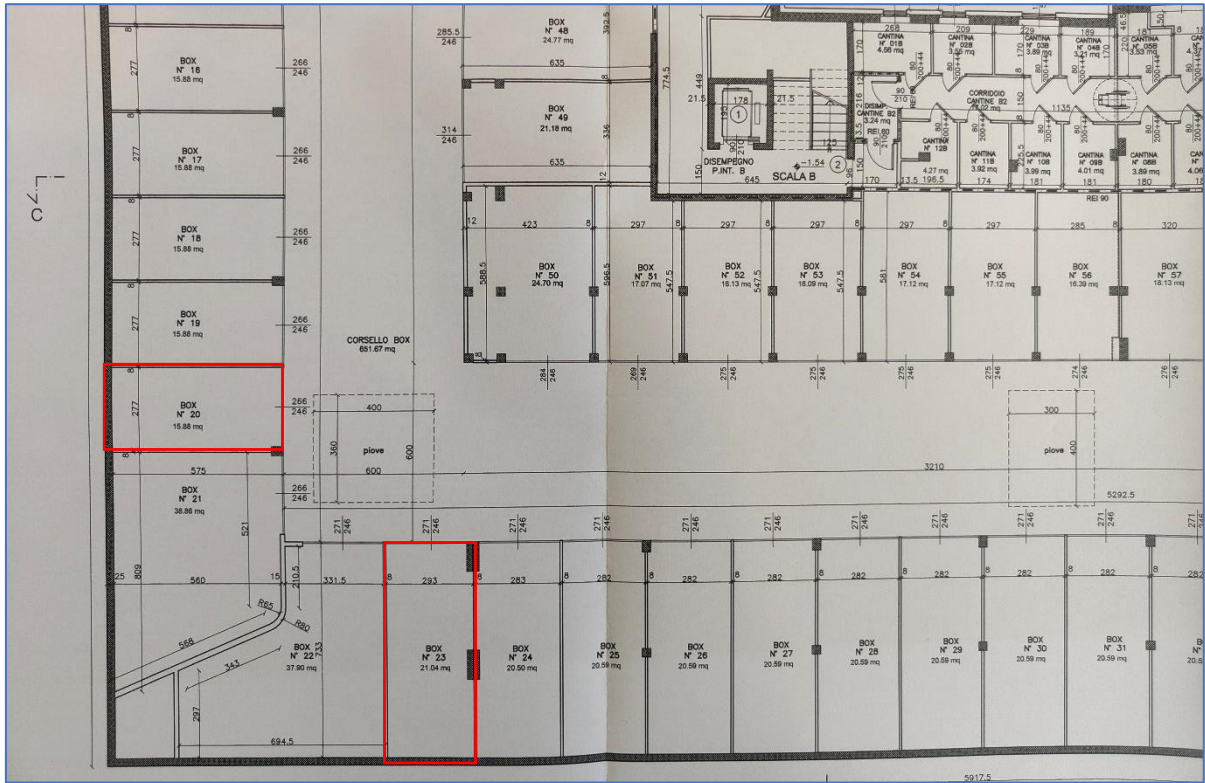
Estratto tavola di progetto Pratica 63/2013 - box
